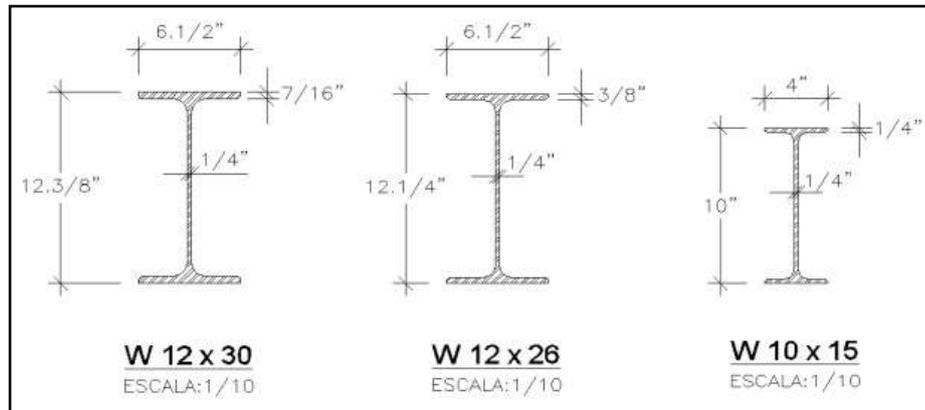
Sección de vigas. FUENTE: Elaboración Propia
